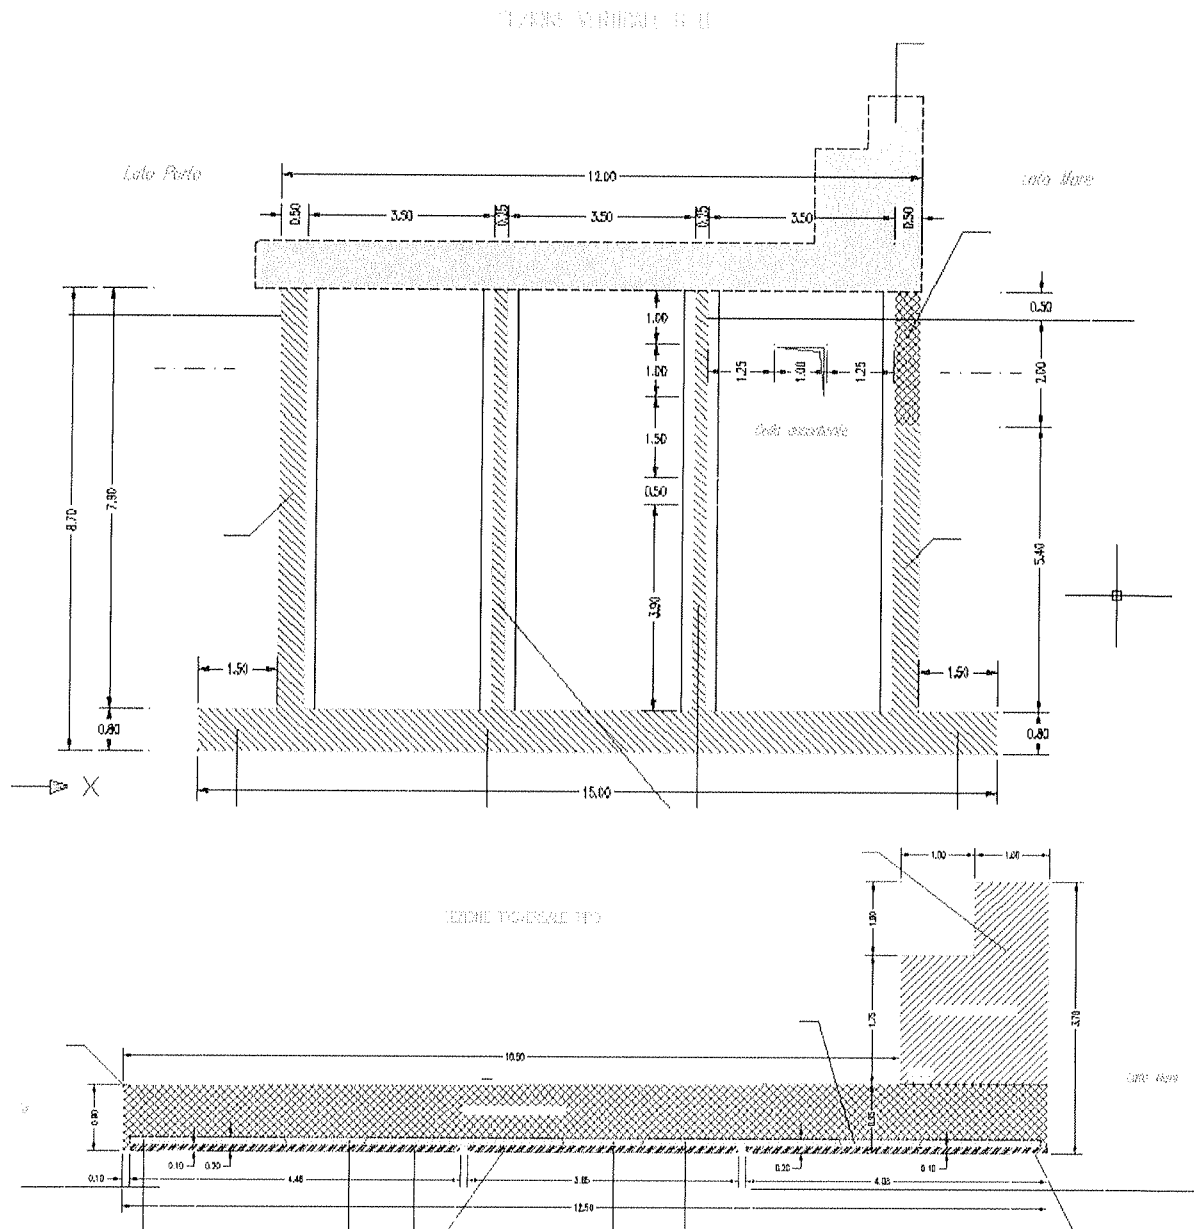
Sezione del cassone e della sovrastruttura (Fonte: progetto Provveditorato OO.PP.)
